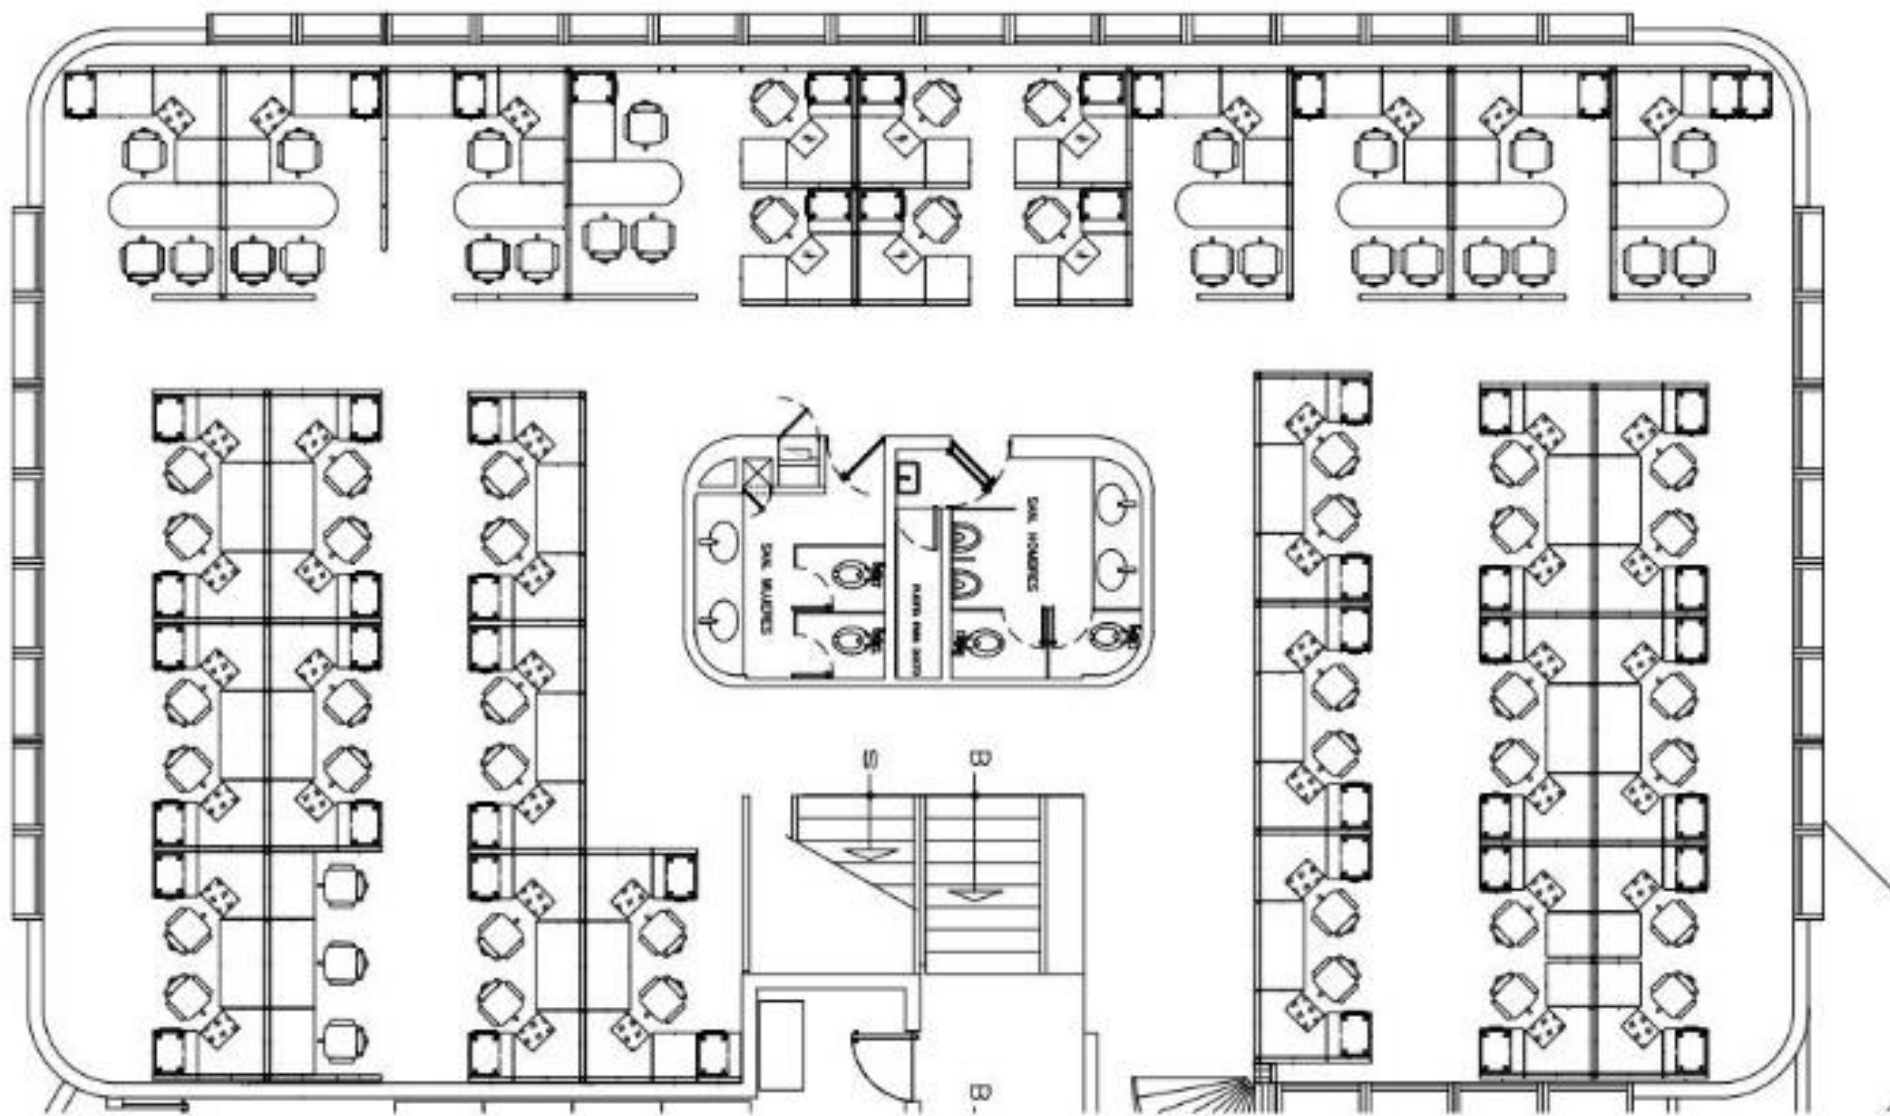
Distribución de planta baja de edificio anexo, cubículos y cubo central de servicios (propiedad del INFONAVIT).
